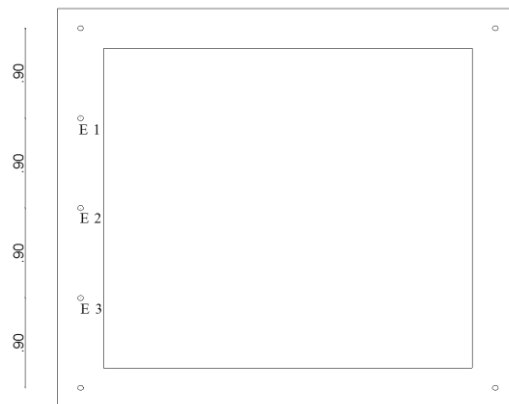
Esquema de anclaje sobre anillo de cimentación.
